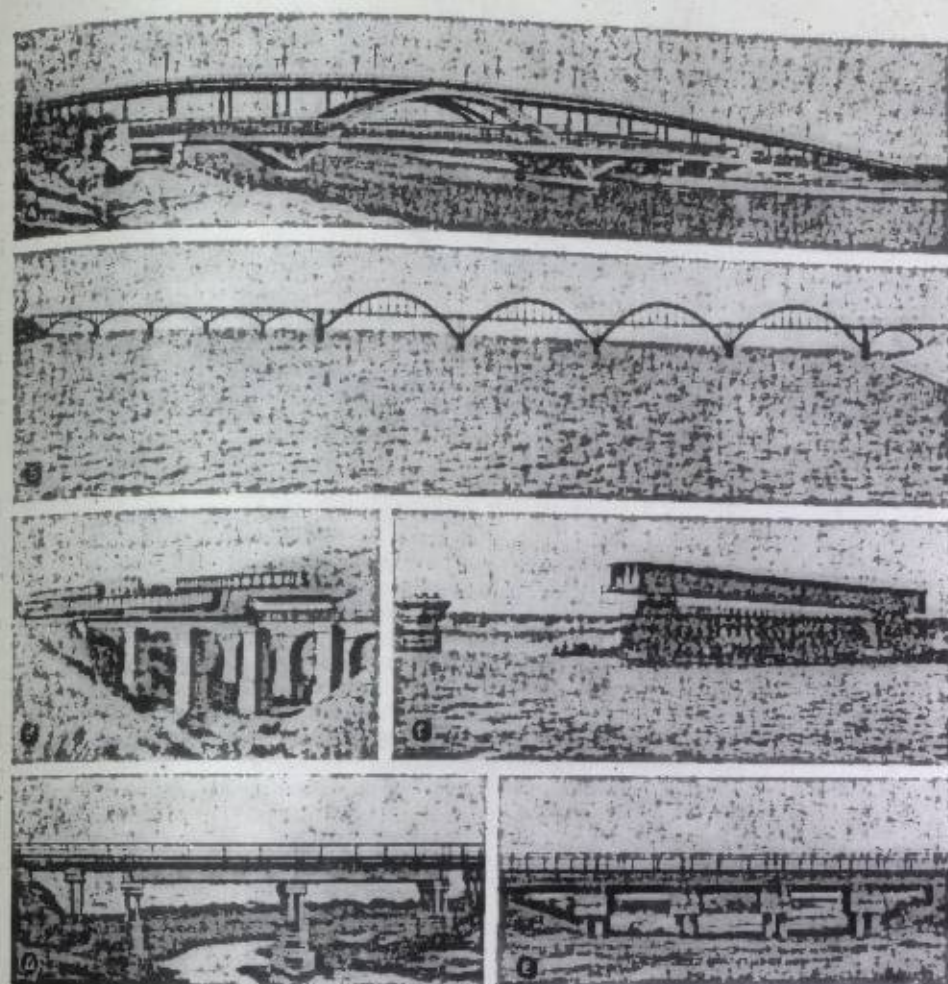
А — двухпролетный сборный предварительно напряженный мост через р. Москву в Лужниках (г. Москва); В — арочный сборный железобетонный мост через р. Оку у г. Горького под ж.-д. нагрузку (пролеты по 150 и 55 м); В — установка железобетонного пролетного строения длиной 16,5 м весом 85 т ж.-д. консольным краном; Г — перевозка на плавучих опорах двух предварительно напряженных балок длиной 85 м и весом 400 т; Д — средний мост сборной конструкции (пролеты 13,5 и 5 м); Е — малый свайно-эстакадный сборный мост с пролетами по 5 м.
